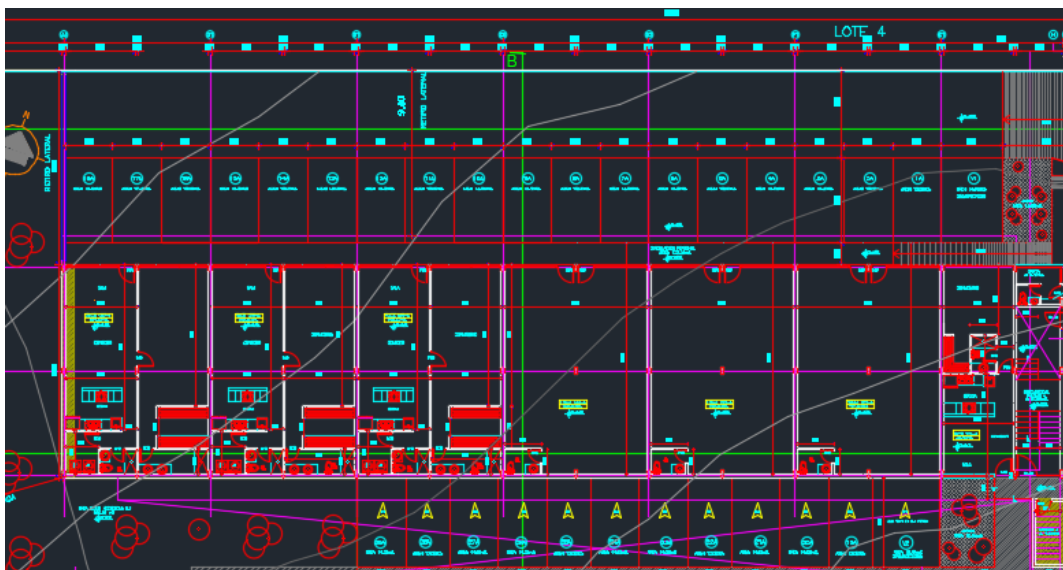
Planta arquitectónica de bloque A optimizado
